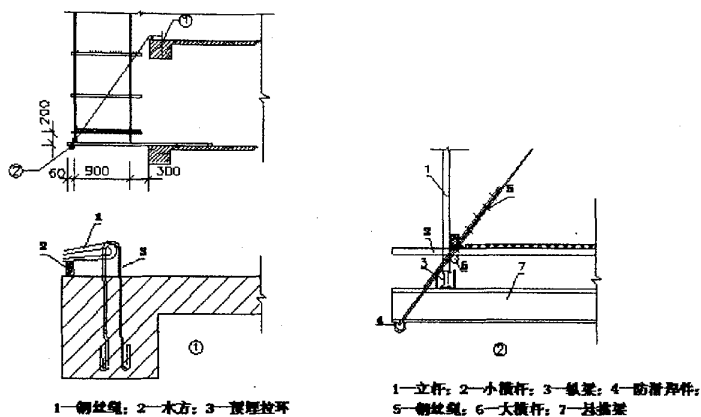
阳角部位挑梁及纵梁立面图
